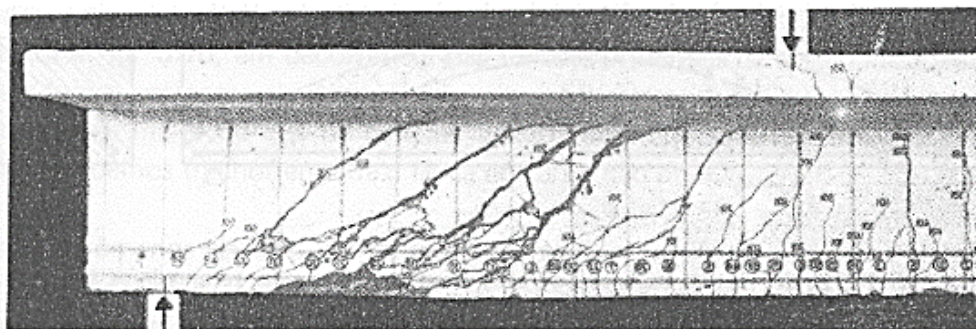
Configuração de fissuras e de ruptura de uma viga T com armadura de cisalhamento (LEONHARDT e MÖNNIG, 1977)
